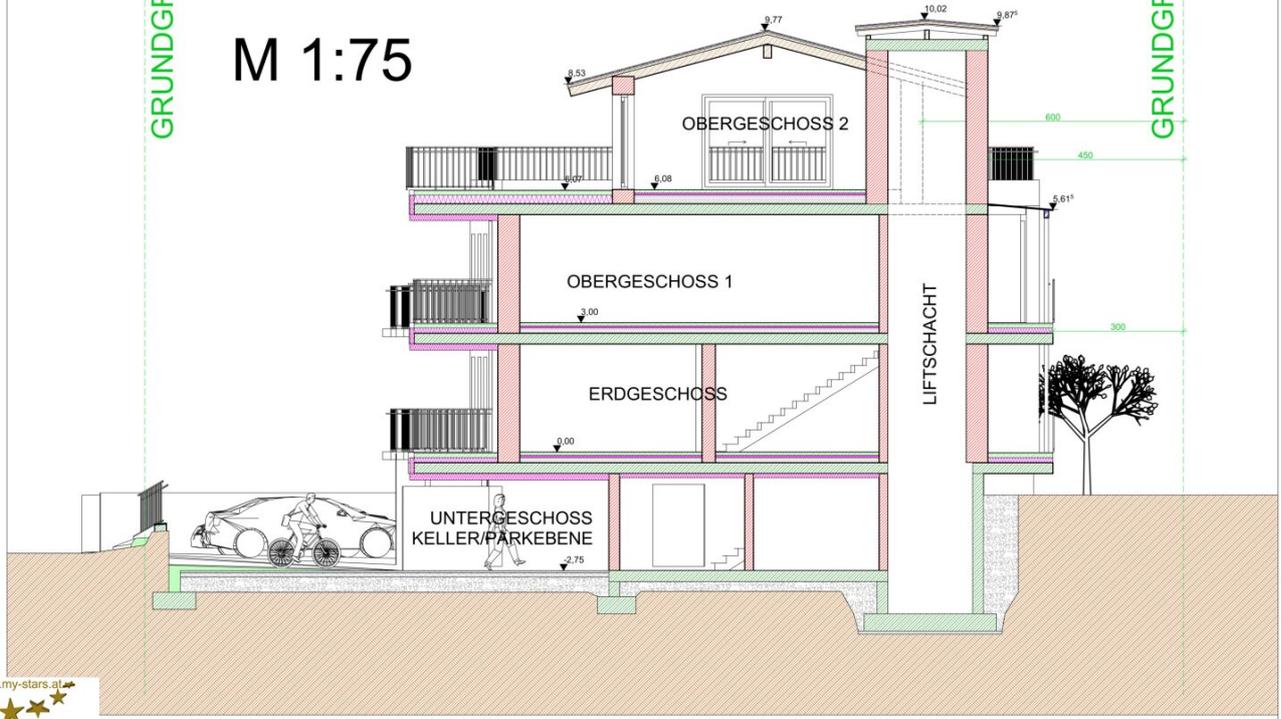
Schnitt gem. Entwurf Bebauungsstudie
